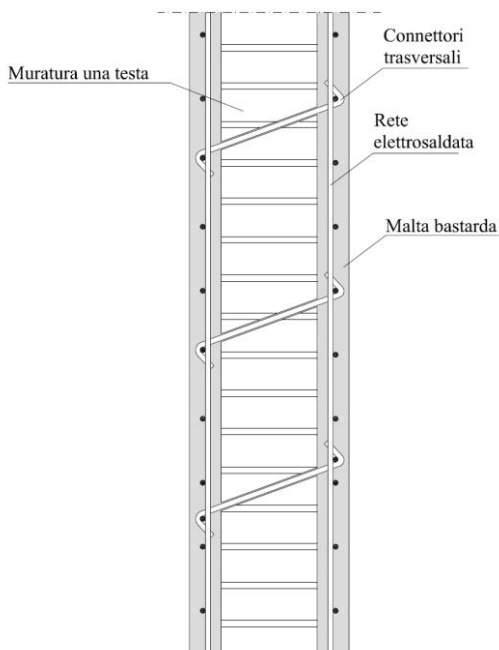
Sezione della parete consolidata con l'intonaco armato su i lati.
